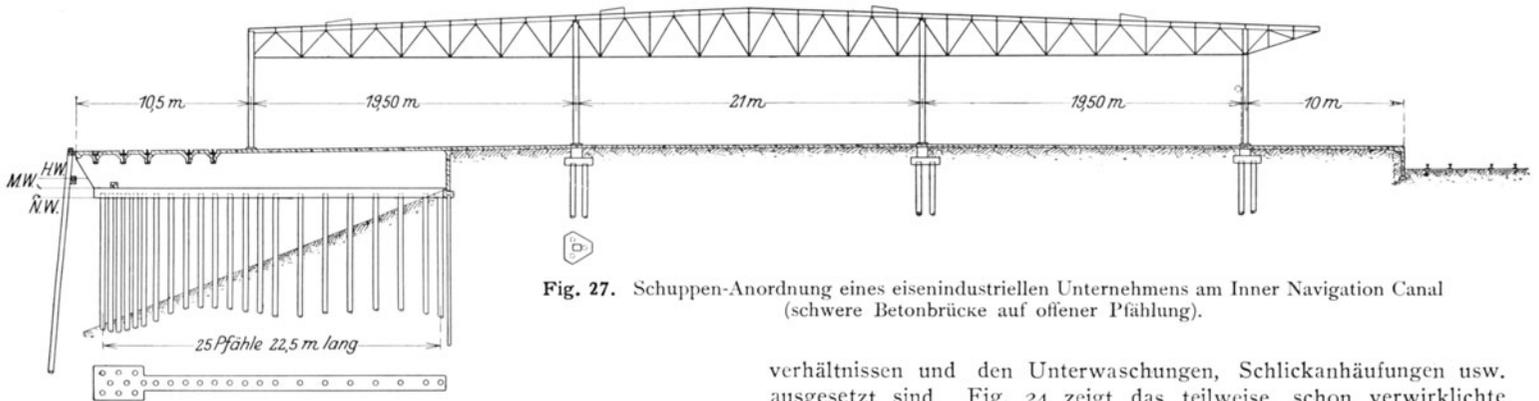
Schuppen-Anordnung eines eisenindustriellen Unternehmens am Inner Navigation Canal (schwere Betonbrücke auf offener Pfählung).
